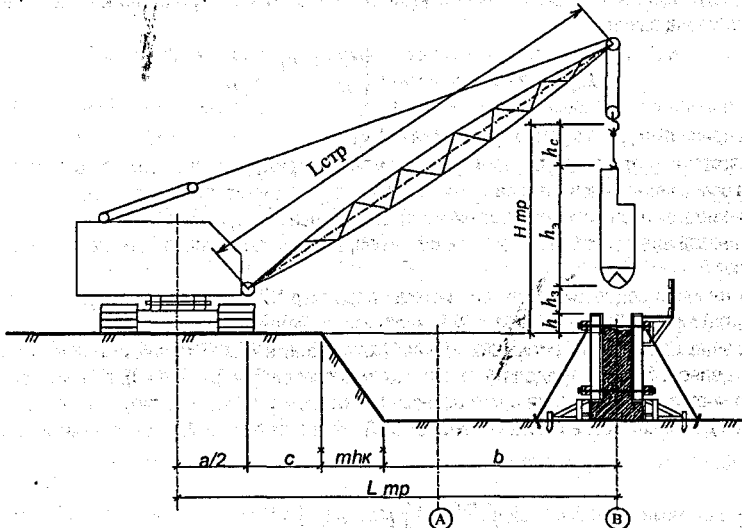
Схема к определению H_{mp} и L_{mp} при подаче бетонной смеси краном в бадью
